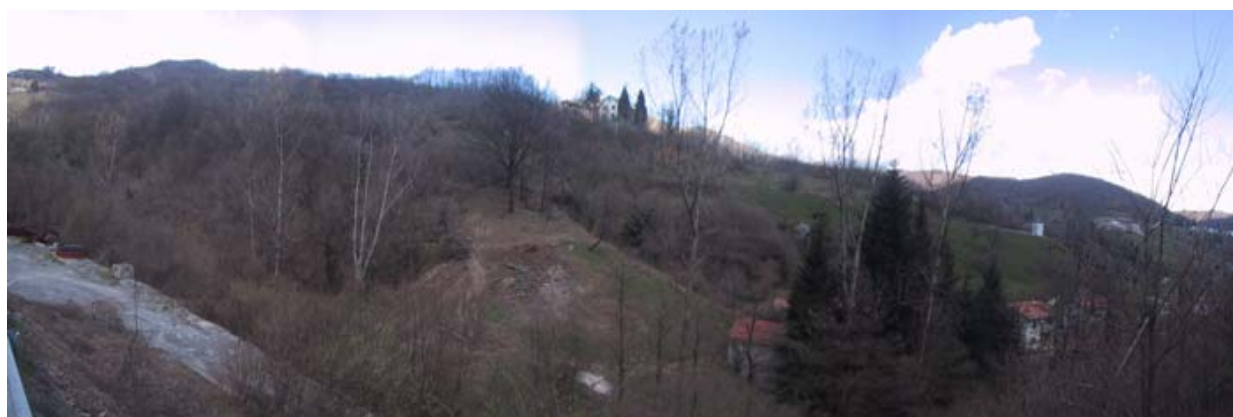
A Panoramica del versante opposto dell'area di cantiere dal suo ingresso
